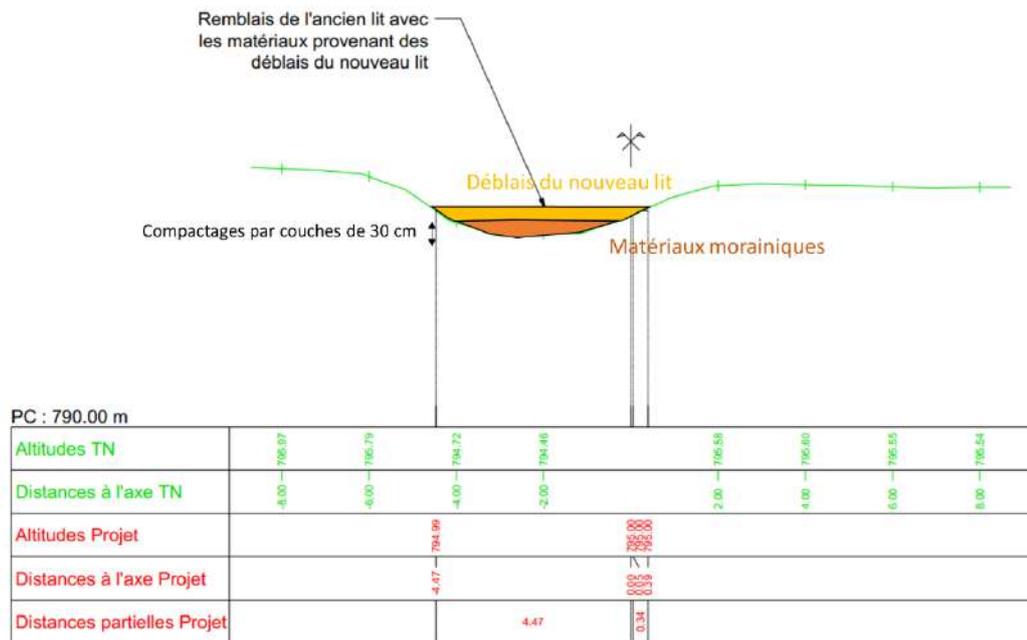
Profil et principe de remblaiement au droit du secteur aval.
